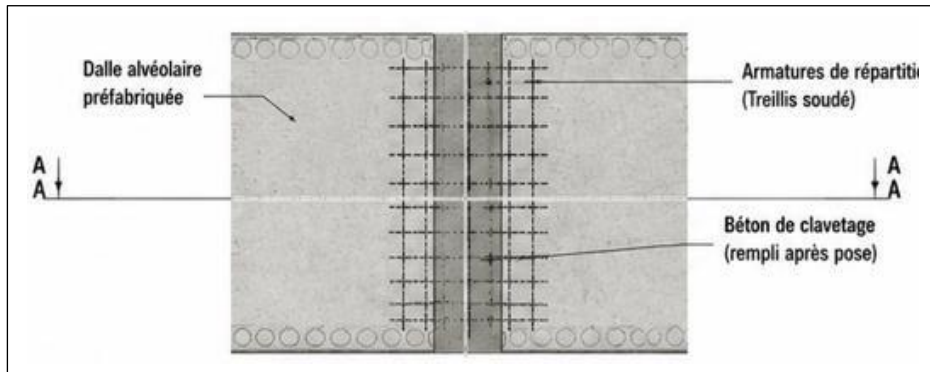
Détail de clavetage et armatures de répartition en dalles.
